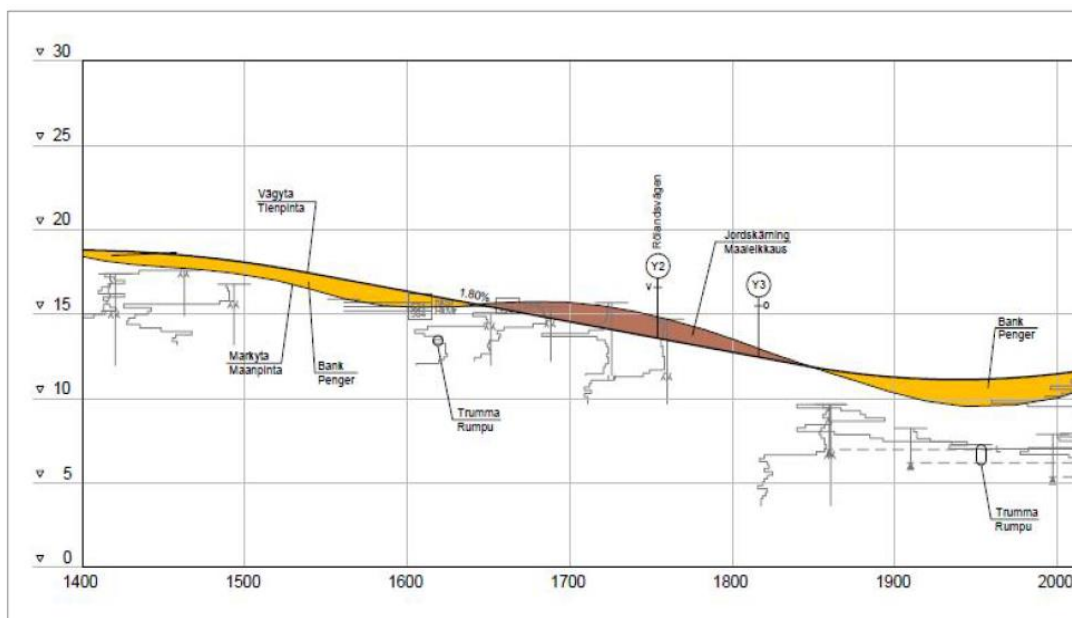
Utdrag av vägplanen (Destia) som visar på åtgärder där vägytan skulle höjas mellan påle 1400-1650, och sänkas mellan påle 1650-1800. Sikten vid infarten till planområdet (Y3) skulle därmed avsevärt förbättras.
